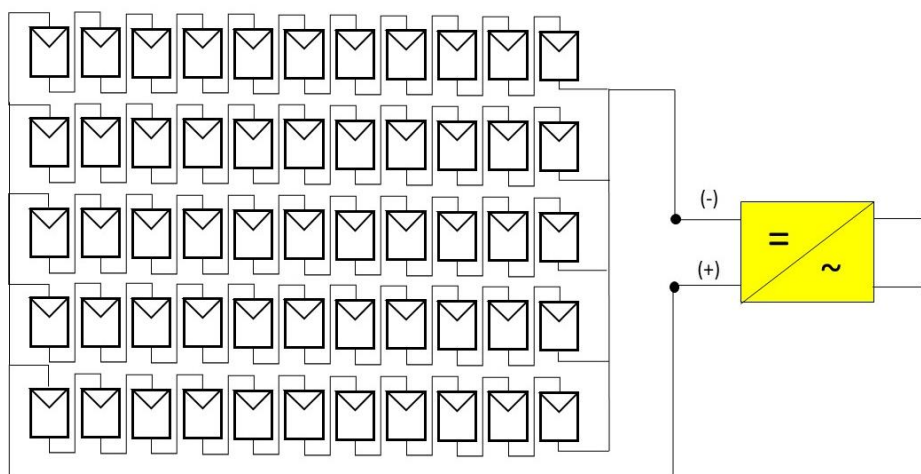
Vista superior do esquema de disposição dos painéis sobre o telhado
